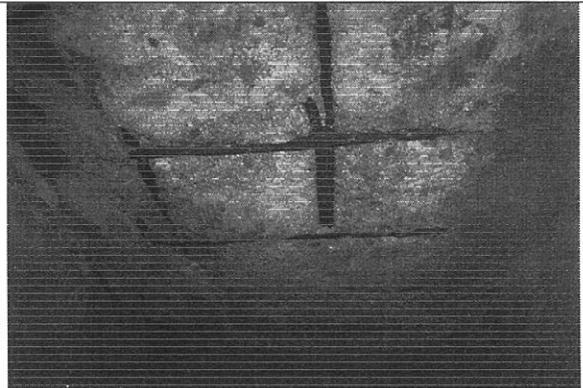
Placa de cubierta zona posterior en mal estado, refuerzo a la vista
